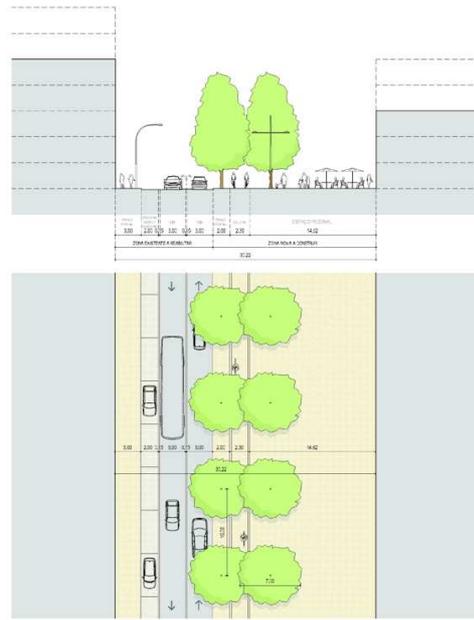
Modelo 3 (perfil tipo) | Projecto de Intervenção para a Avenida Dr. Lourenço Peixinho | Proposta preliminar p.48
